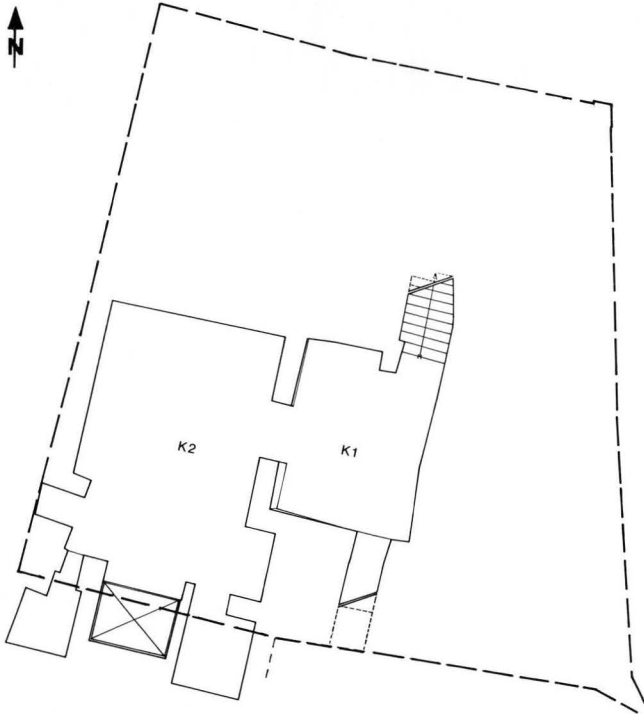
Grundriss der Keller. Der Umriss des Hauses im Parterre ist gestrichelt wiedergegeben. K 1 Keller des 15. Jh.; K 2 Keller von 1715. (Der südliche Teil ist durch den Lifteinbau in jüngster Zeit verändert worden.) – Zeichnung: M. Merki. – Massstab 1:200.
